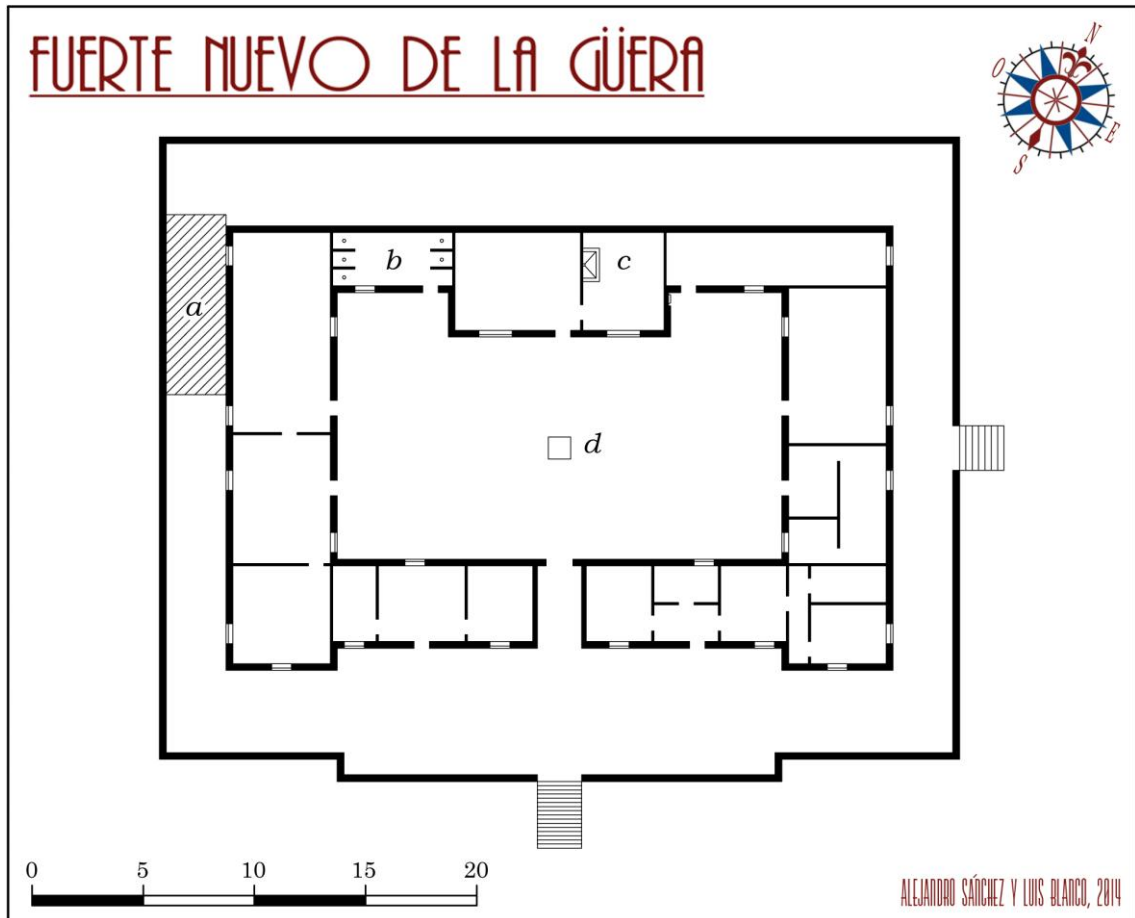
Planta del fuerte nuevo (a: añadido para letrinas, b: duchas, c: chimenea, d: aljibe)
